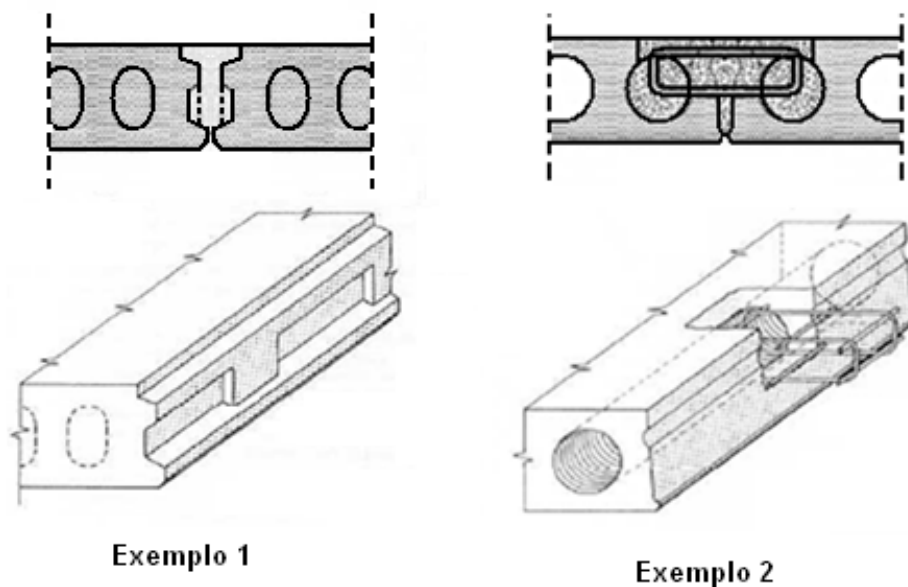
Ligação laje-laje com lajes alveolares (Stupré, 1981)
